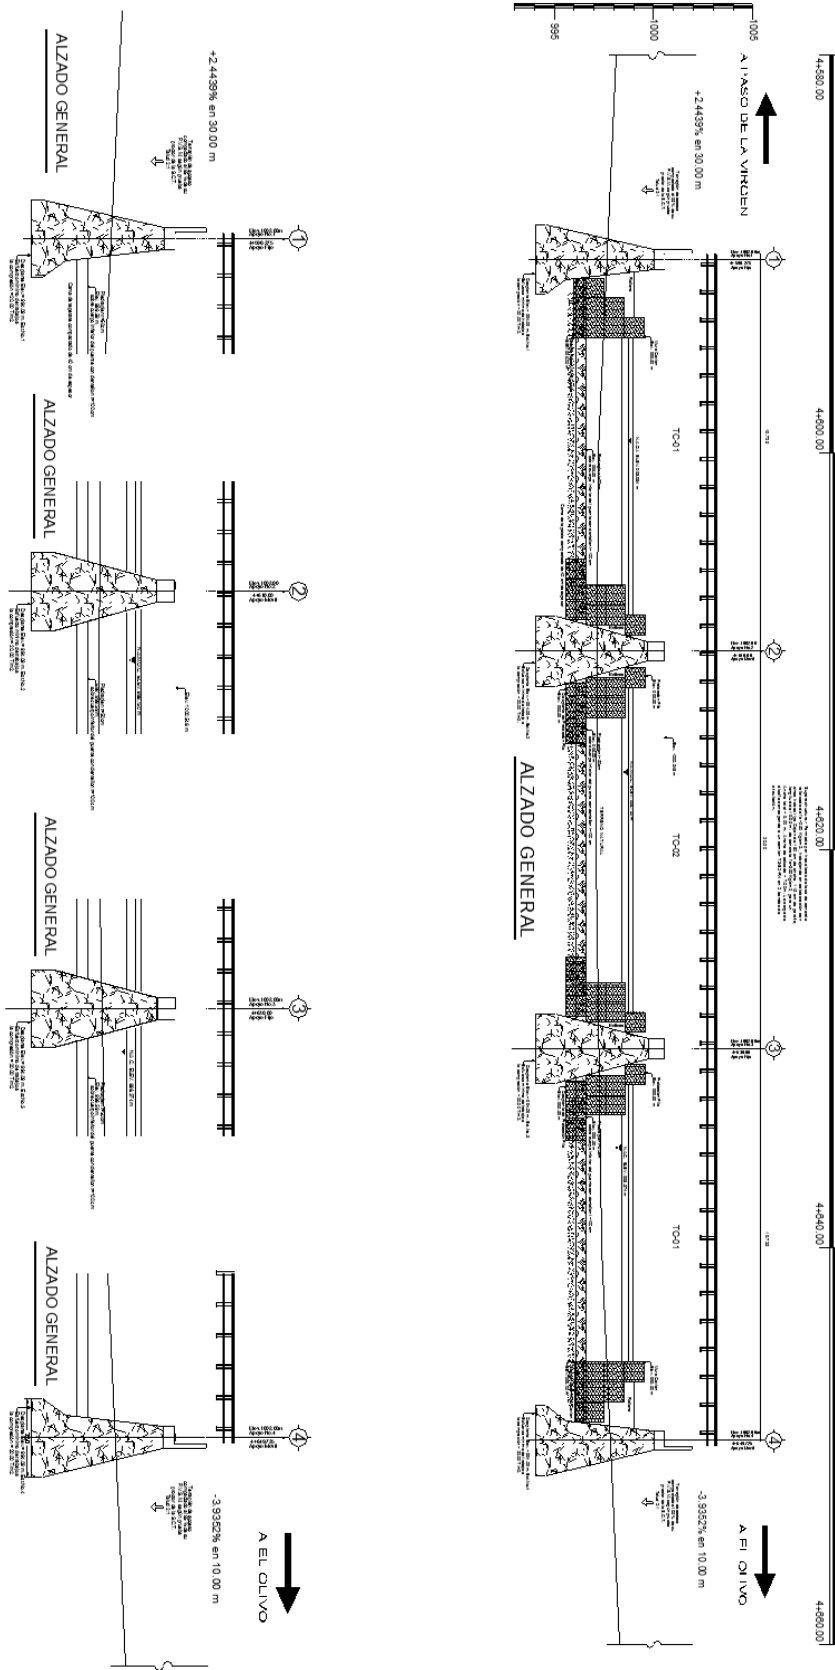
Planos estructurales del Puente paso de la Virgen.
